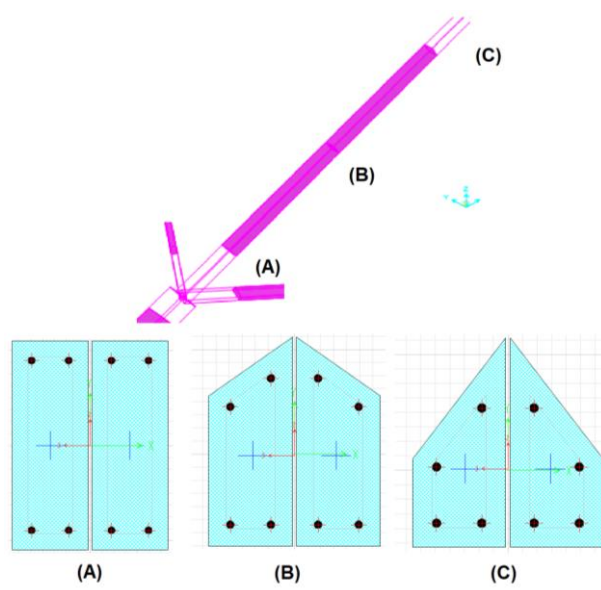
Secciones en el elemento 02 columna inclinada desde la intersección con las vigas inclinadas hasta la punta de la estructura rectangular y trapezoidal (A) 0.20m x 0.55m, (B) 0.20m x 0.36m x 0.53 m y (C) 0.20m x 0.19m x 0.44m.
